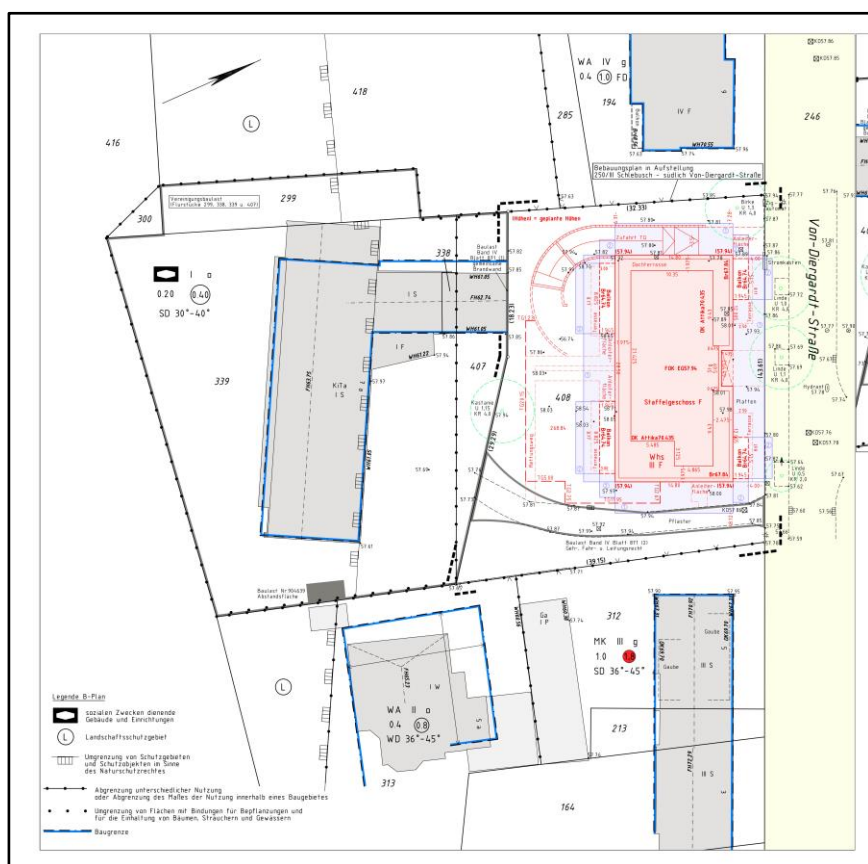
Lageplan Bauvorhaben, Kita sowie Zu/Abfahrt über Von-Diergardt-Straße, ohne Maßstab, Nordpfeil beachten
